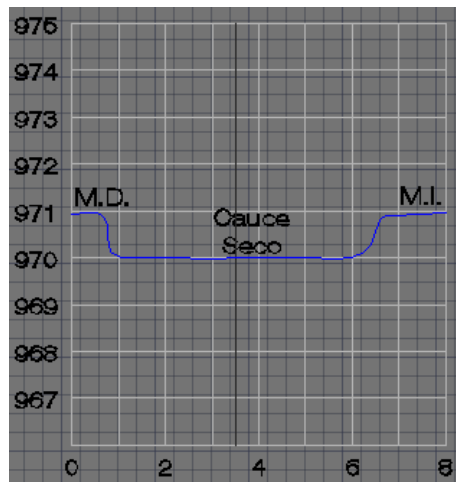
Sección transversal actual. No. 16 K1 + 210
